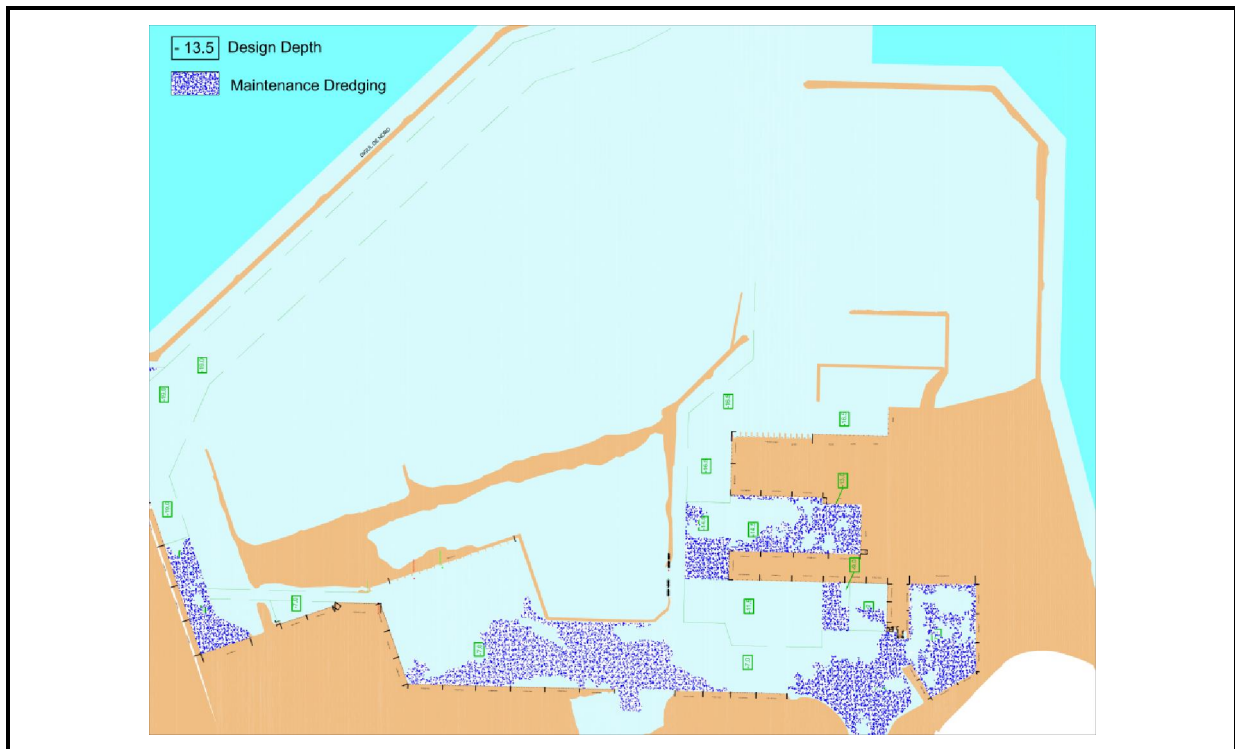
Plan de dragare de mentenanță portul Constanța.
